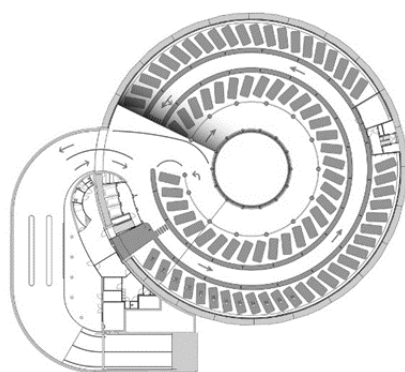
План и центральная рампа подземного паркинга Lammermarkt Parking Garage
